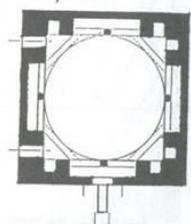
مكرر) مسقط أفقي لبقعة أبو تراب بالعباسية -
